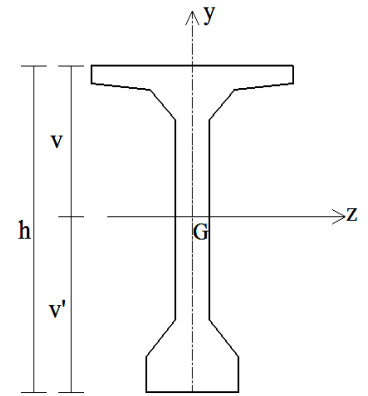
Axes principaux et position du C.D.G d'une section typique de poutre
